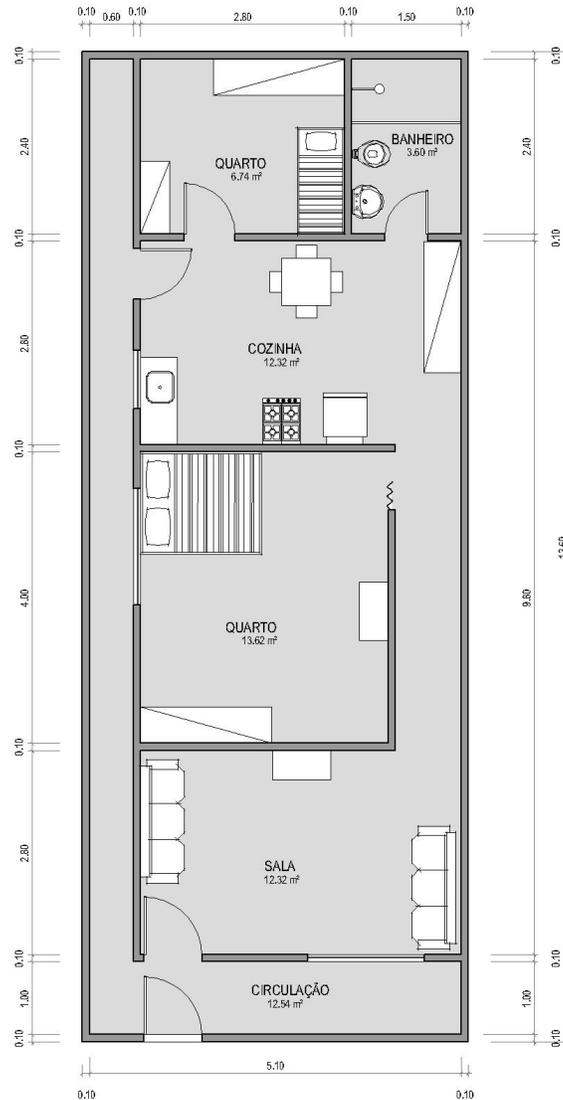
Planta baixa da casa da Sra. Judith. Área: 48,82 m².
